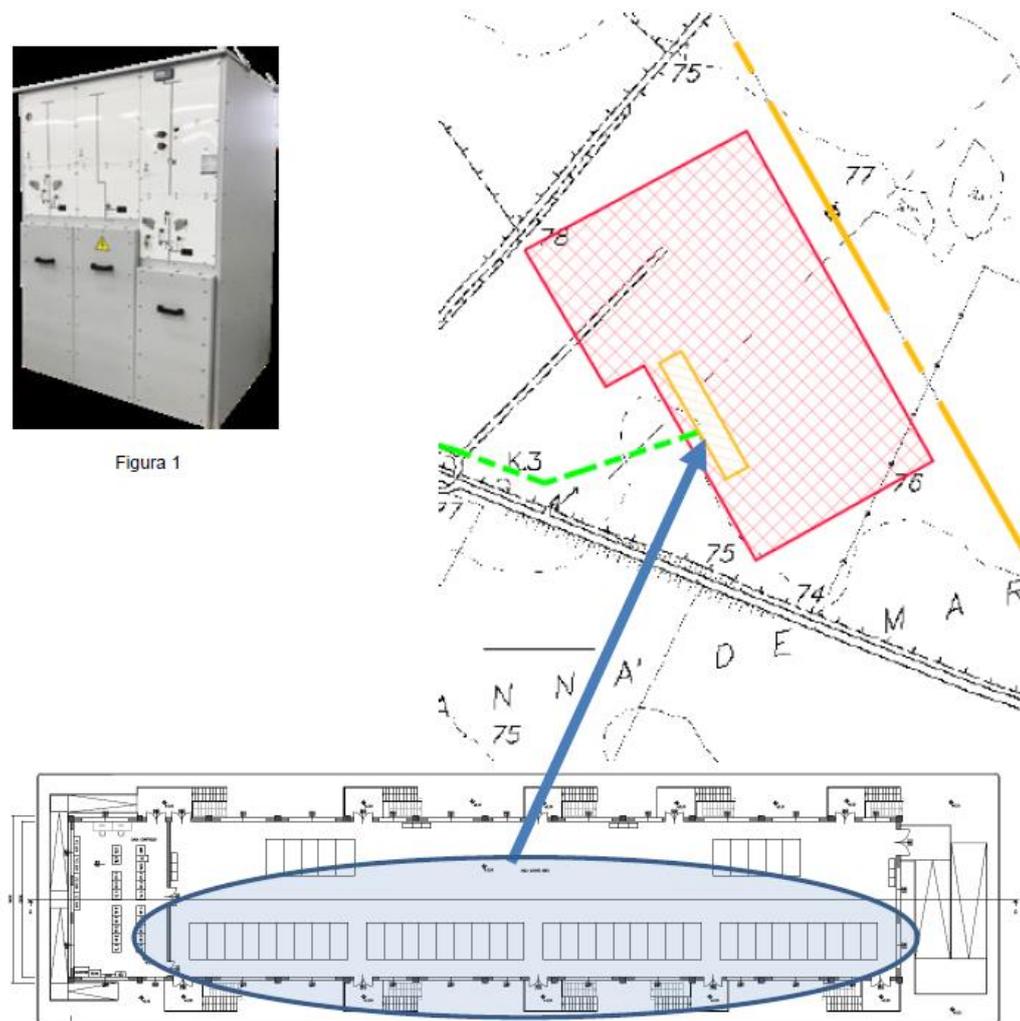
Dettaglio collegamento AT stazione elettrica Olmedo 380
